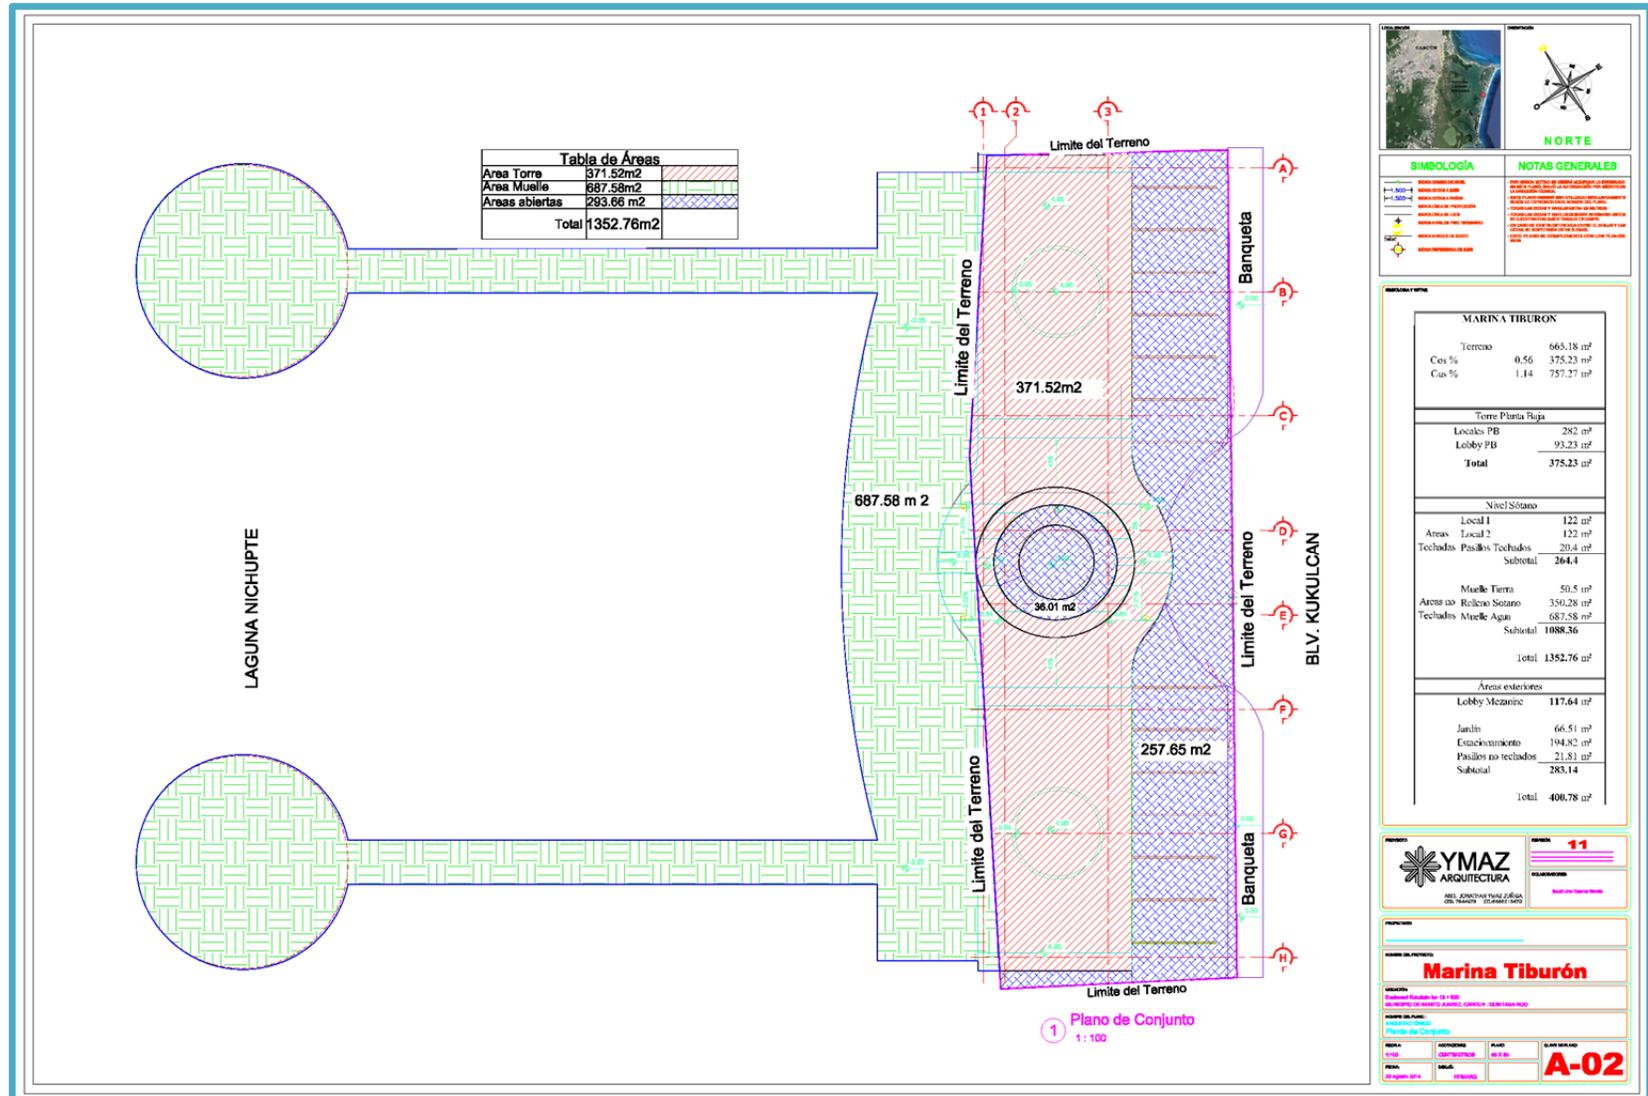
Plano de Conjunto. Fuente: Imaz Arquitectura/2014.
